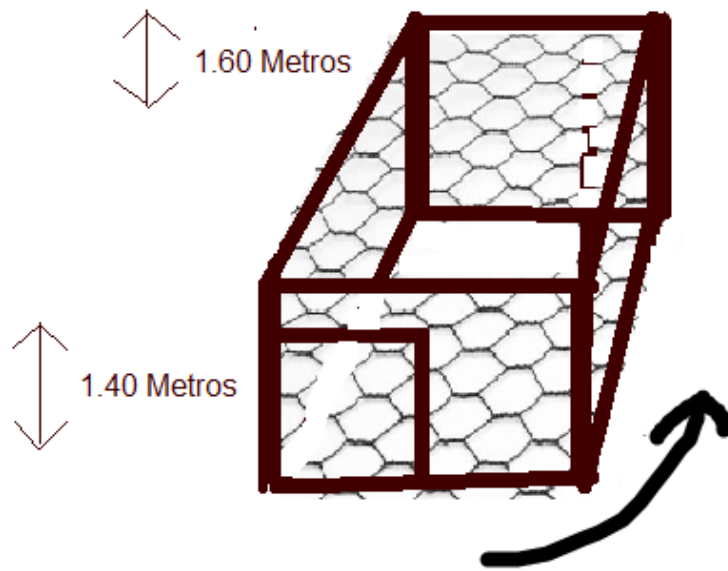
Ejemplo de la estructura y la colocación del alambre para gallinero
